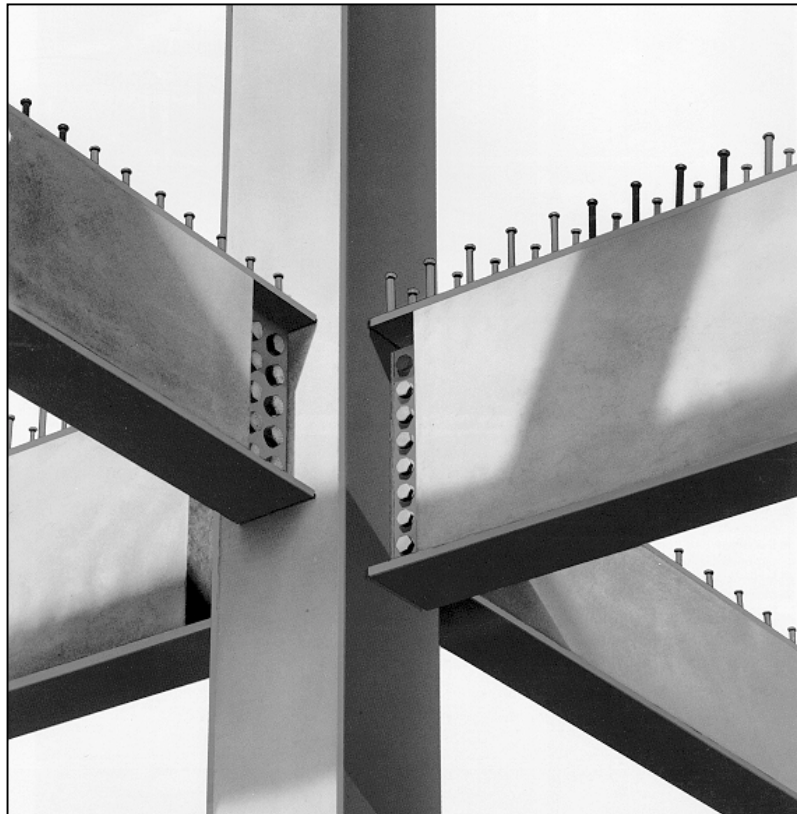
Fahnenblechanschluß eines kammerbetonierten Trägers an die Stütze [1.1]
